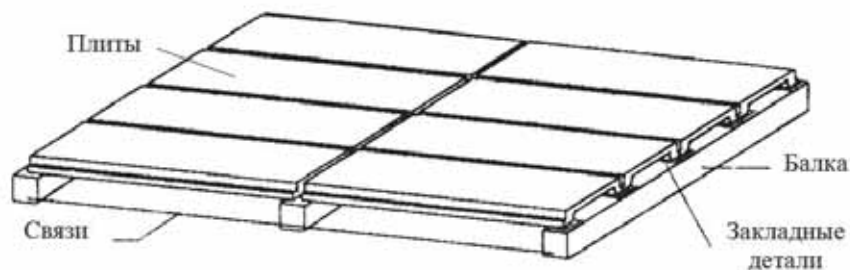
Конструкция фрагмента покрытия для испытания закладных деталей
